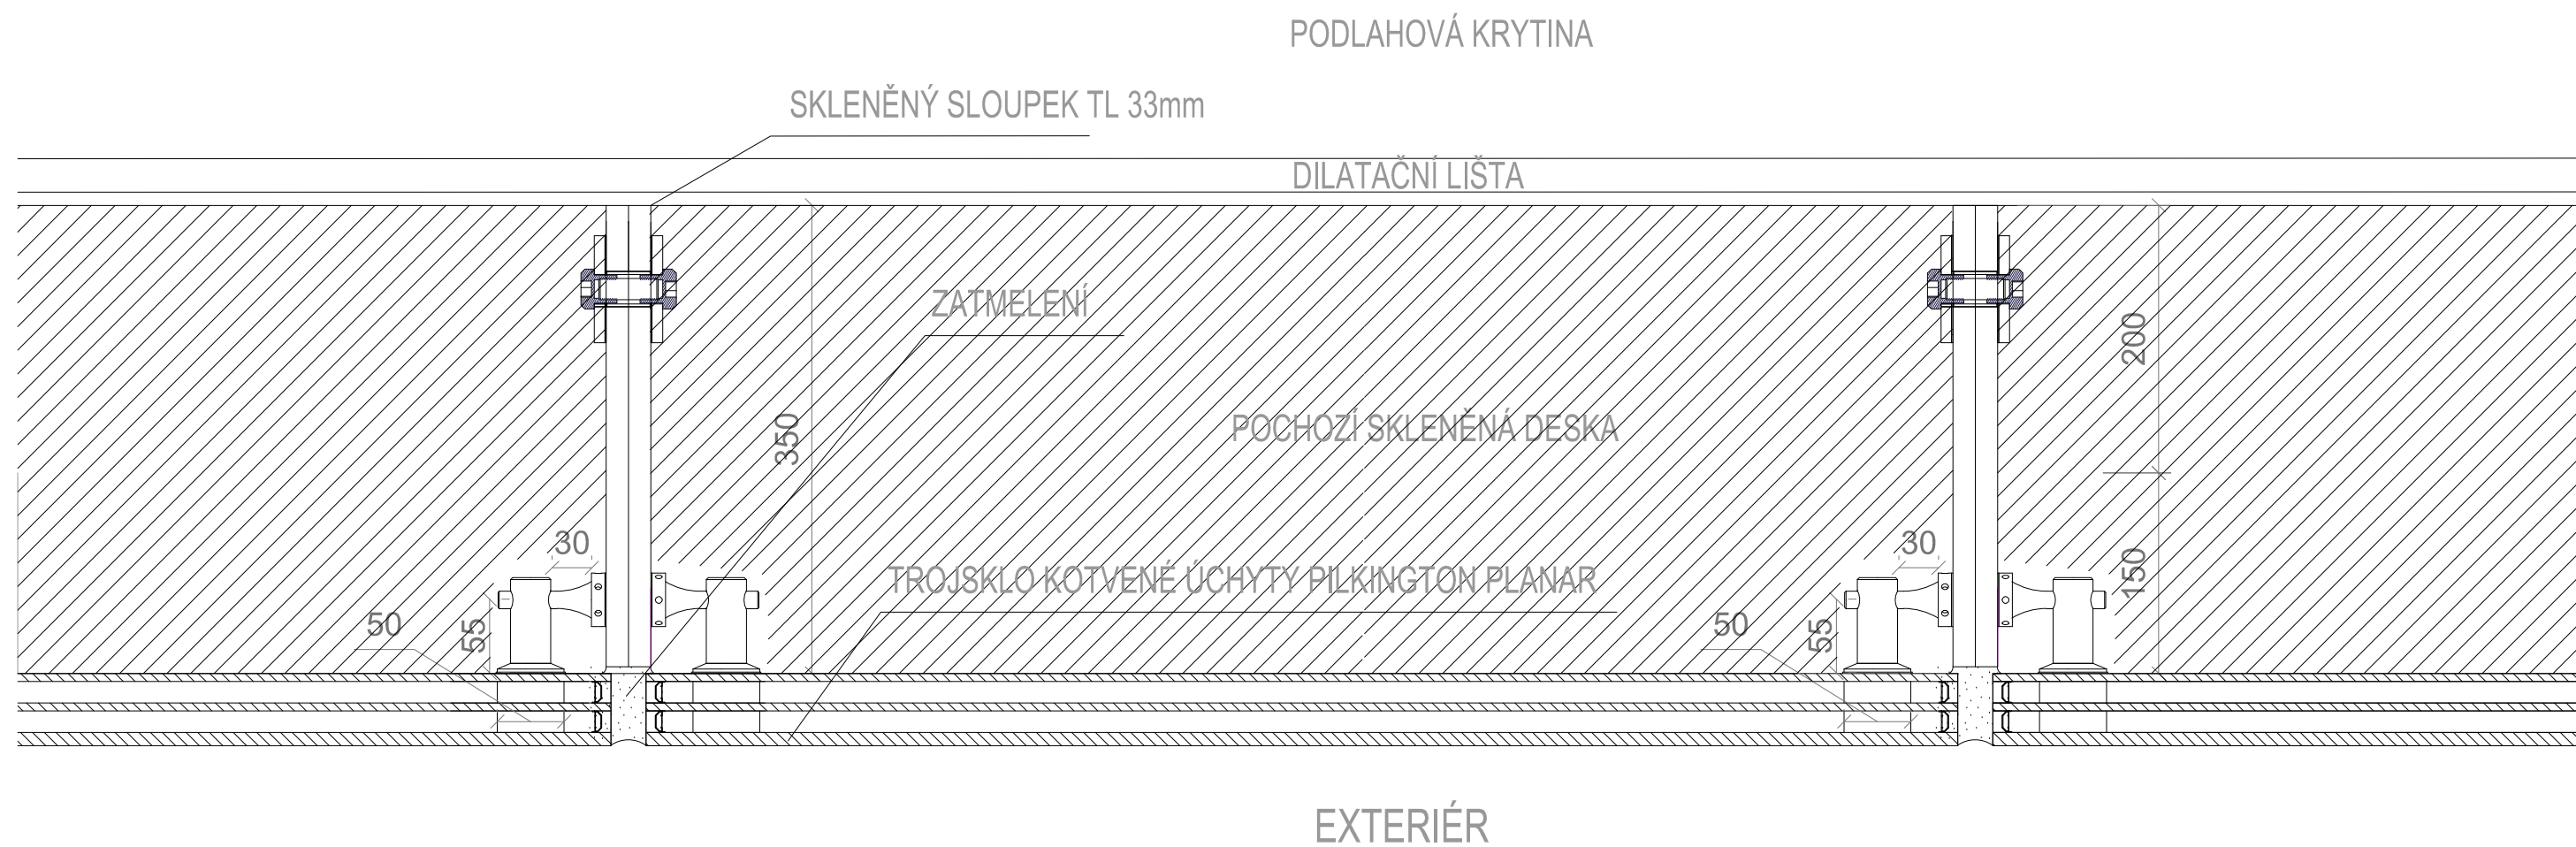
DETAIL ULOŽENÍ FASÁDNÍHO PLÁŠTĚ
